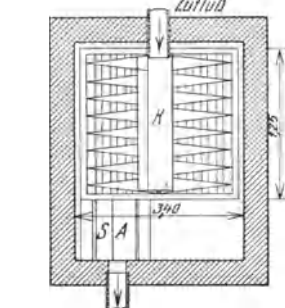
Klein-Tropfkörper mit Lattenkörper für Hauskläranlagen. (Nach W. Teschner)
